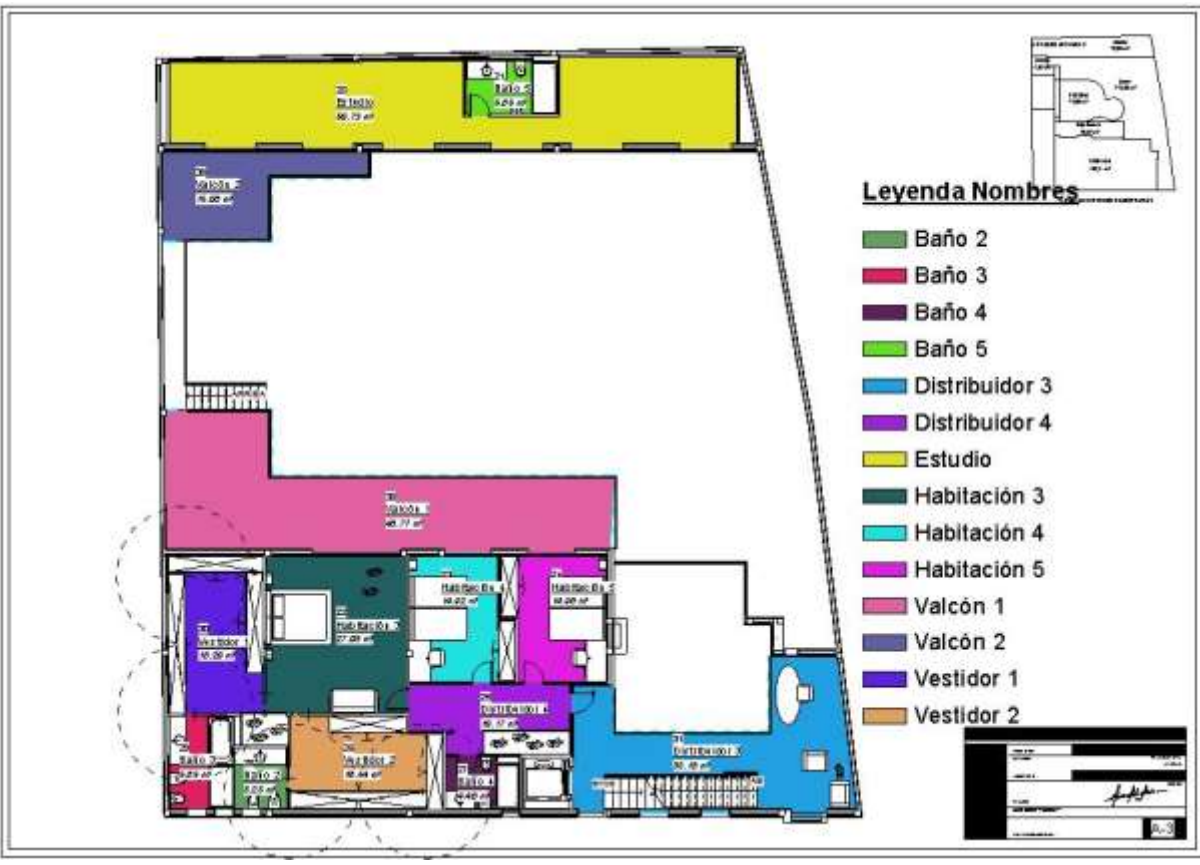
Plano de Superficies. Planta Primera. Fuente propia. 2016
